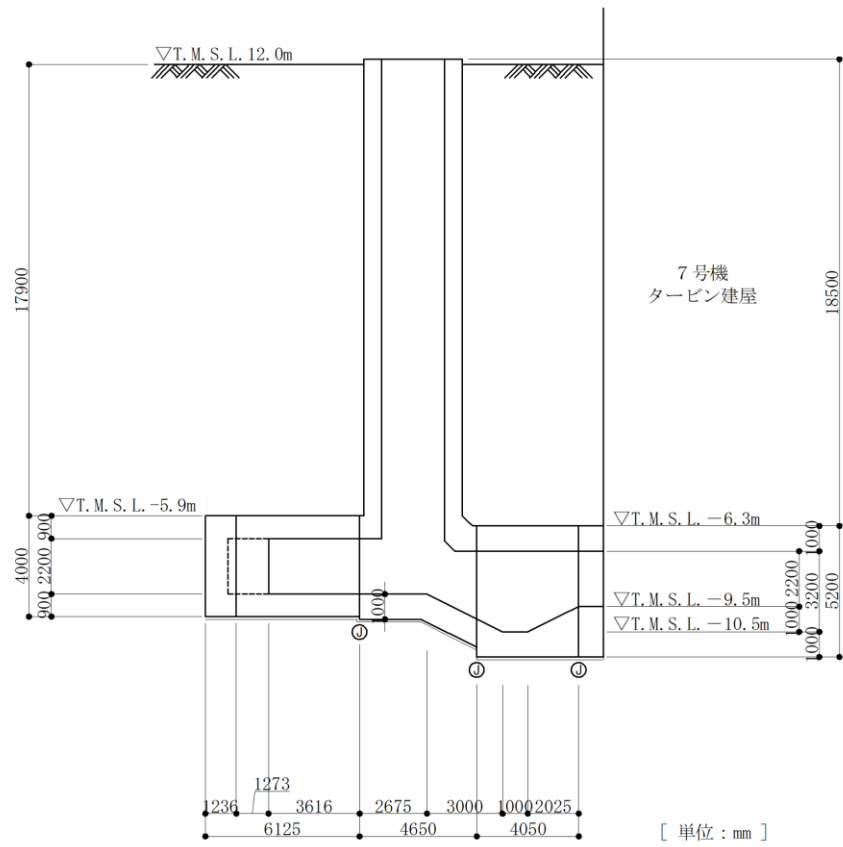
補機冷却用海水取水路（南側）の断面図（B-B断面）
